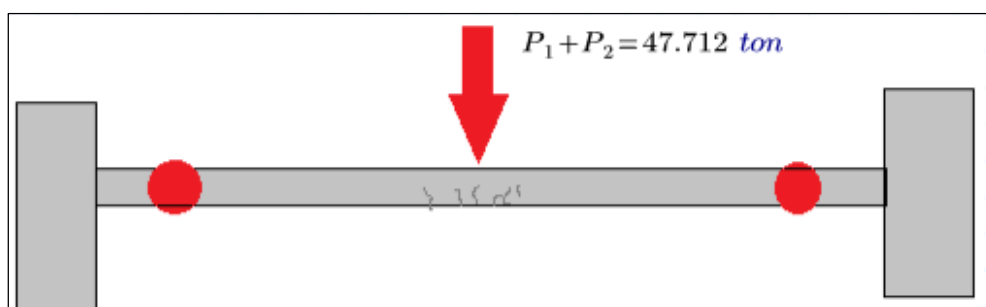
Ejemplo de aplicación-rotulas plásticas en los extremos de la viga
